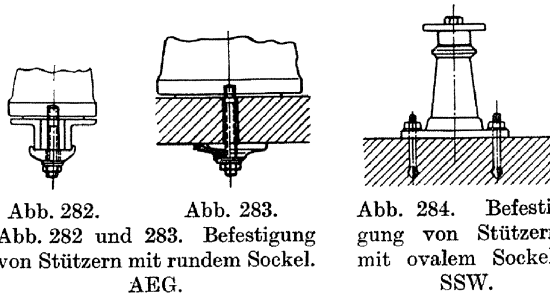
Abb. 283. Befestigung von Stützern mit rundem Sockel. AEG.
